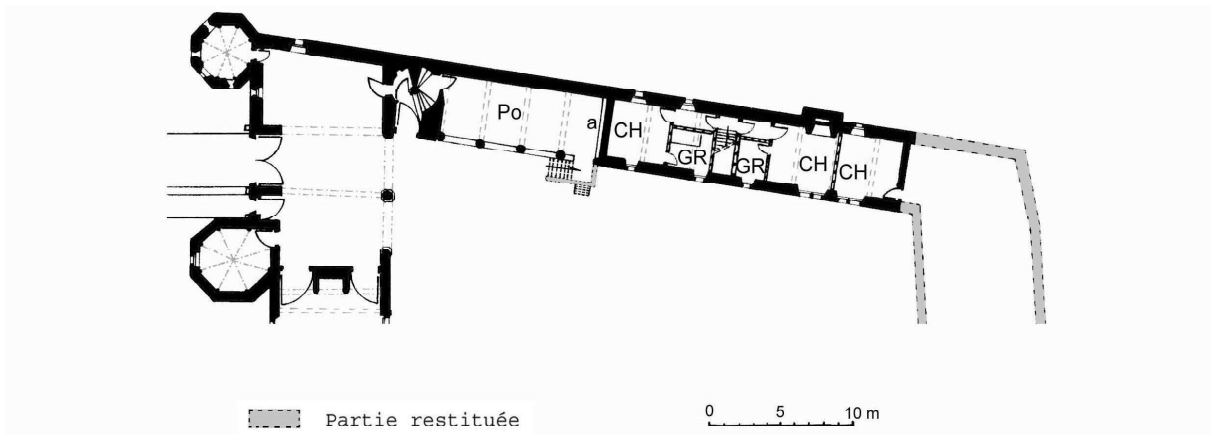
Les Maillets. Plan restitué du rez-de-chaussée surélevé et du niveau d'entresol entre 1535 et 1545.
